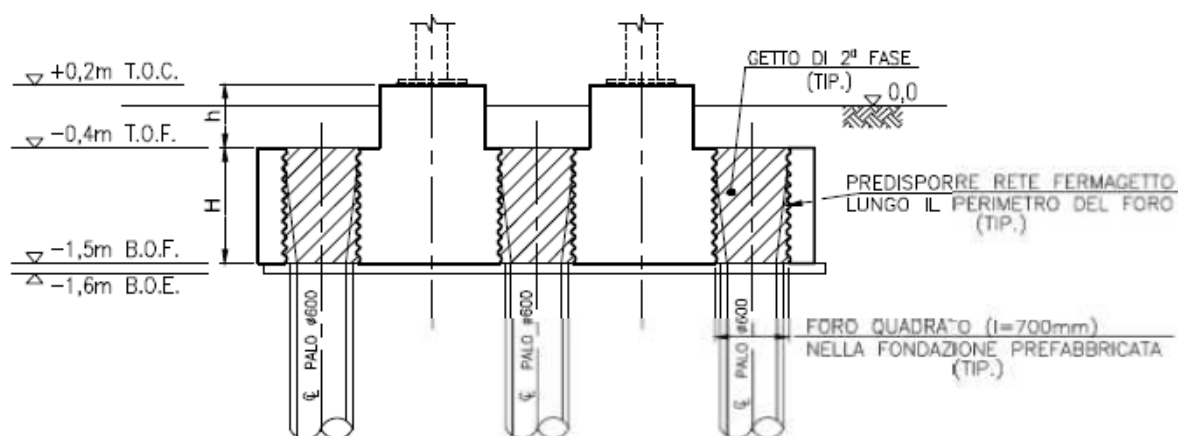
Esempio di fondazione con plinto a 6 pali
